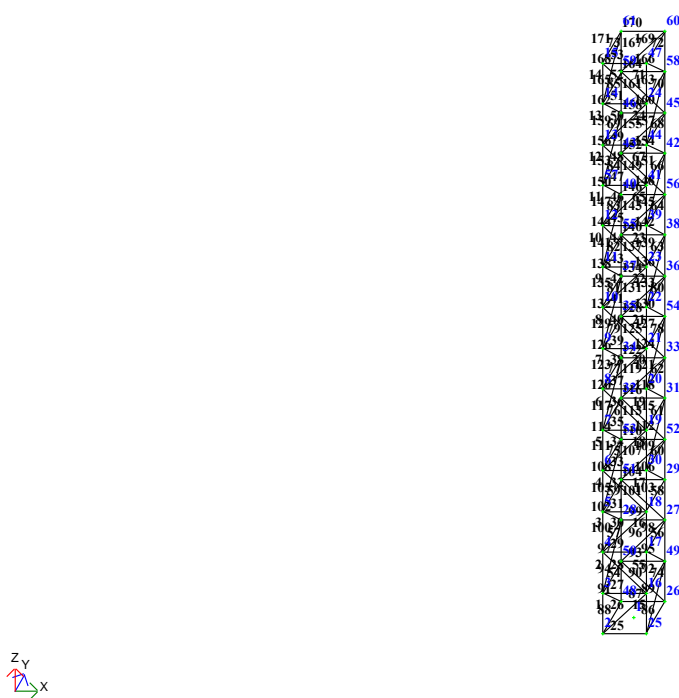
Розрахункова схема конструкції кріплення труби
